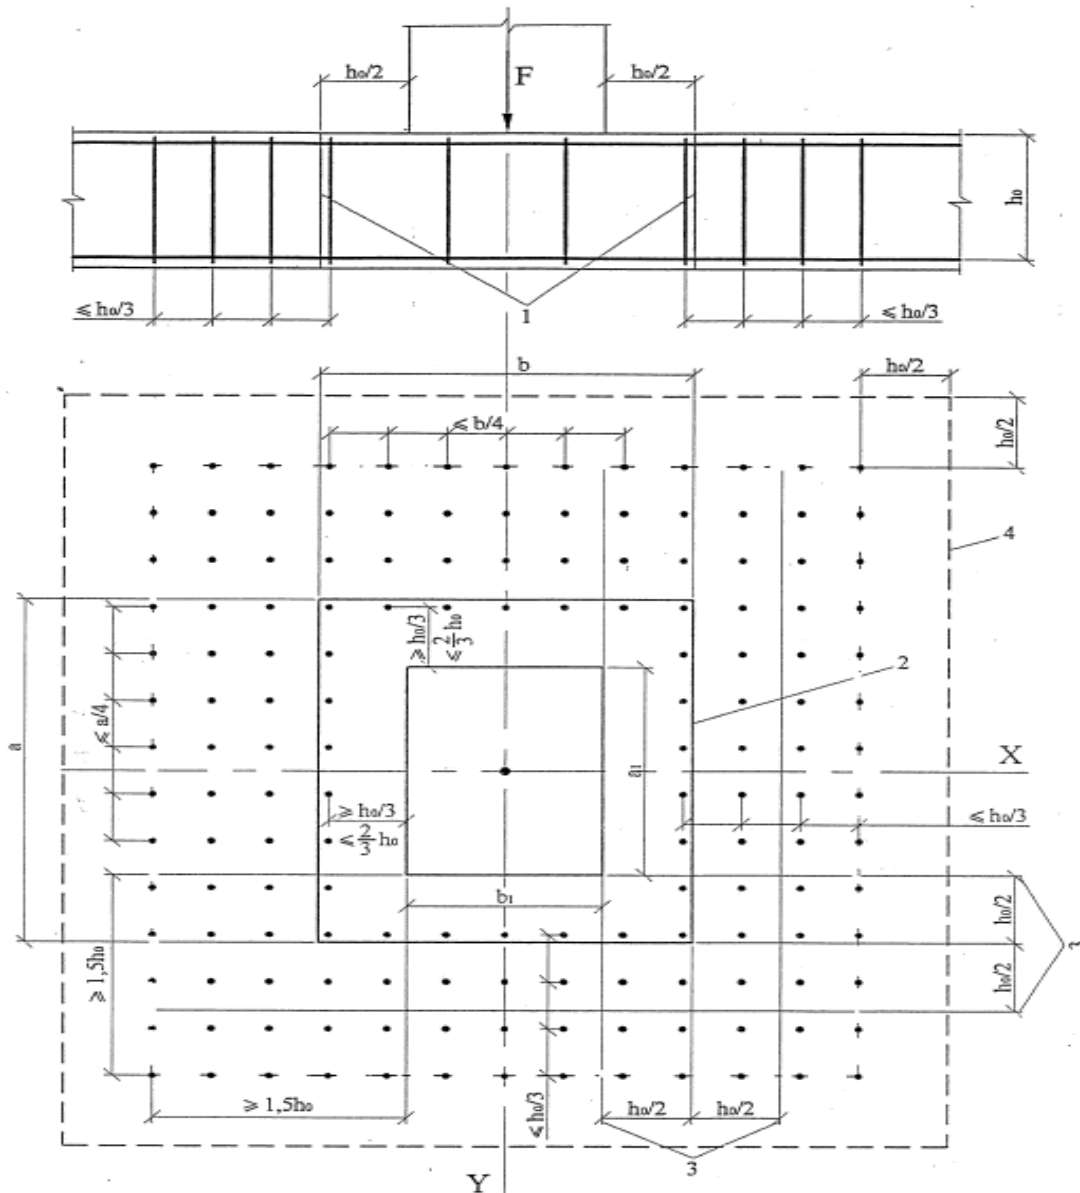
Схема для расчета железобетонных плит с вертикальной равномерной распределенной поперечной арматурой на продавливание.
